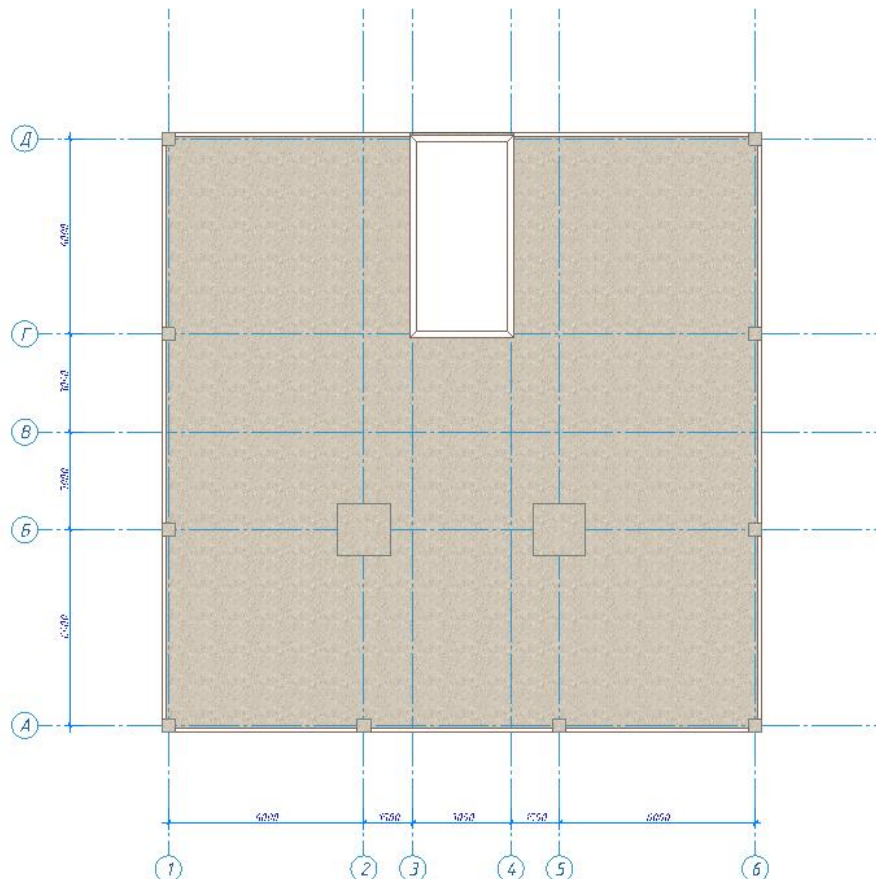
Расположение проема в плите перекрытия (вид сверху)
